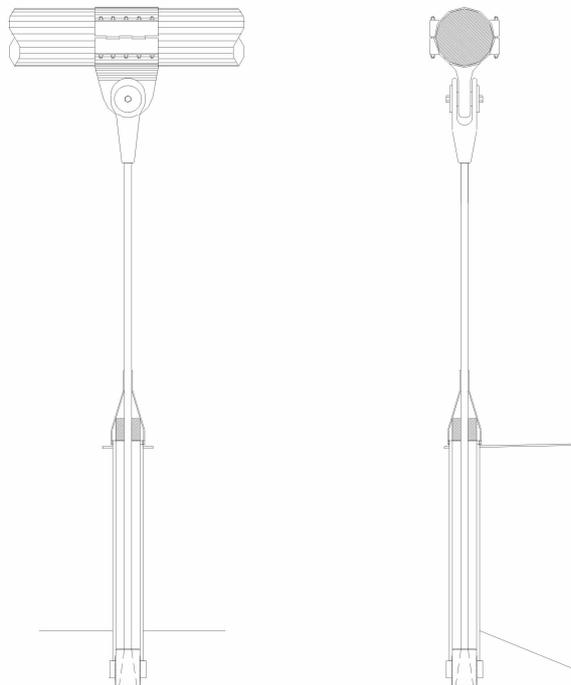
Detalles de conexión de las péndolas al cable principal y al tablero.
